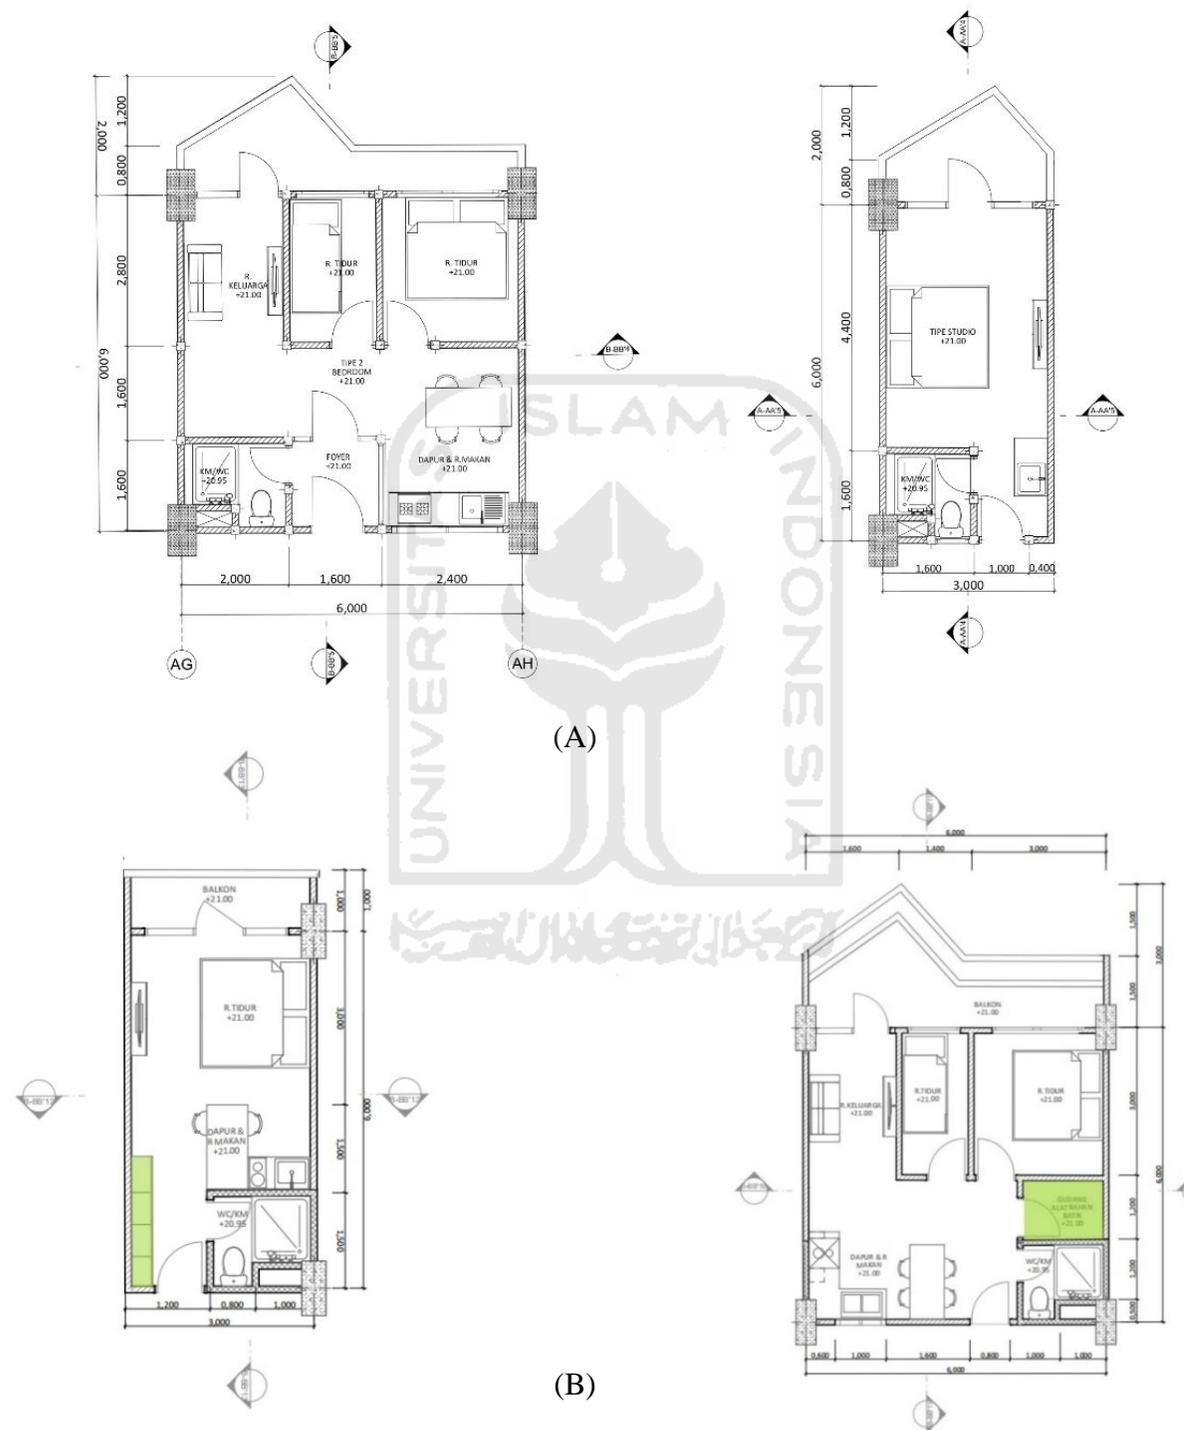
3 (A) Denah Lantai 1 Sebelum Evaluasi, (B) Denah Lantai 1 Setelah Evaluasi
